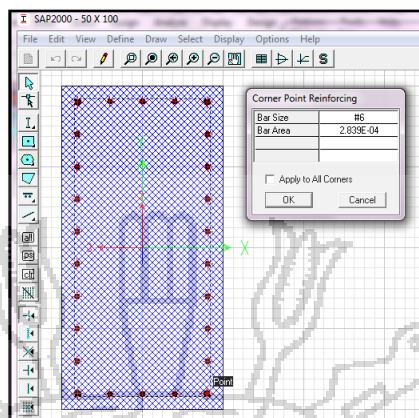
REFUERZO COLOCADO EN LA COLUMNA C-3 (50X100).
